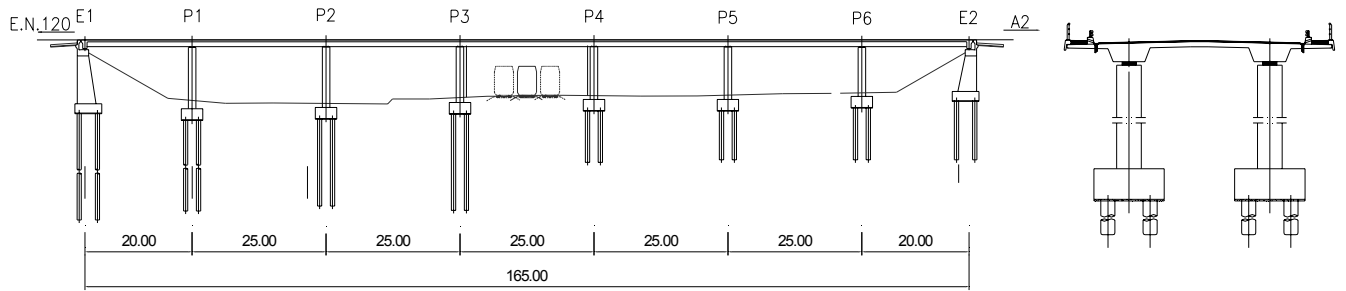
Corte Longitudinal e Transversal de VIADUTO
